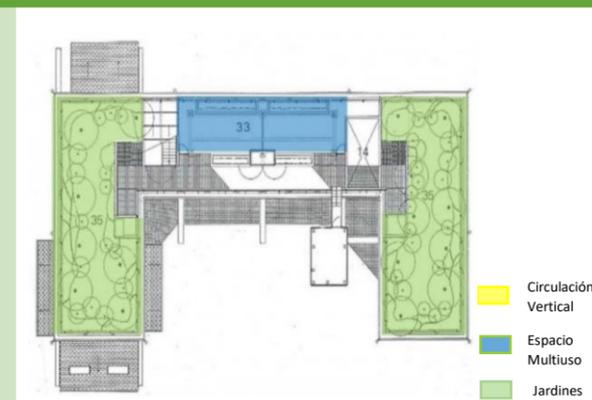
Planta terraza Proyecto Osaka Gas NEXT-21
